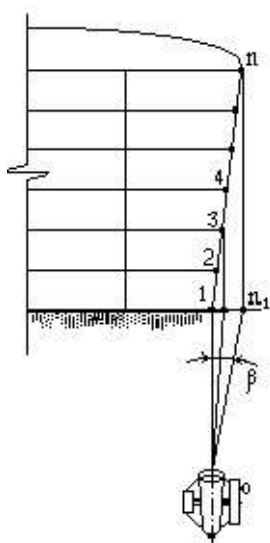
Схема измерения горизонтальных смещений образующей стенки резервуара.
